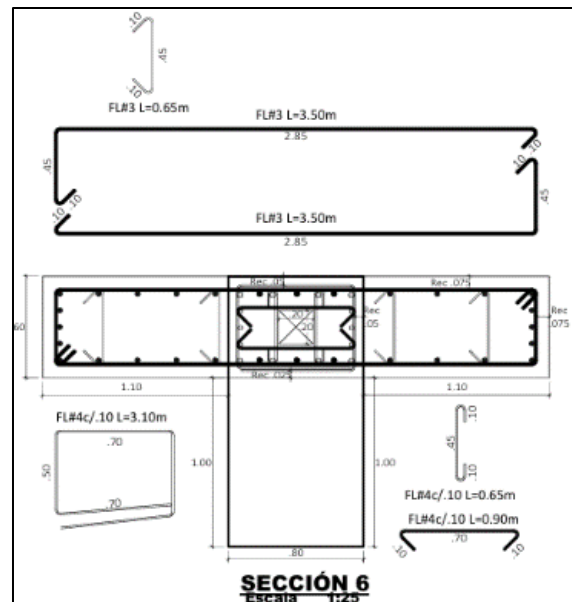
Detalle del Refuerzo Vertical del Elemento Pantalón 110 – T10.
